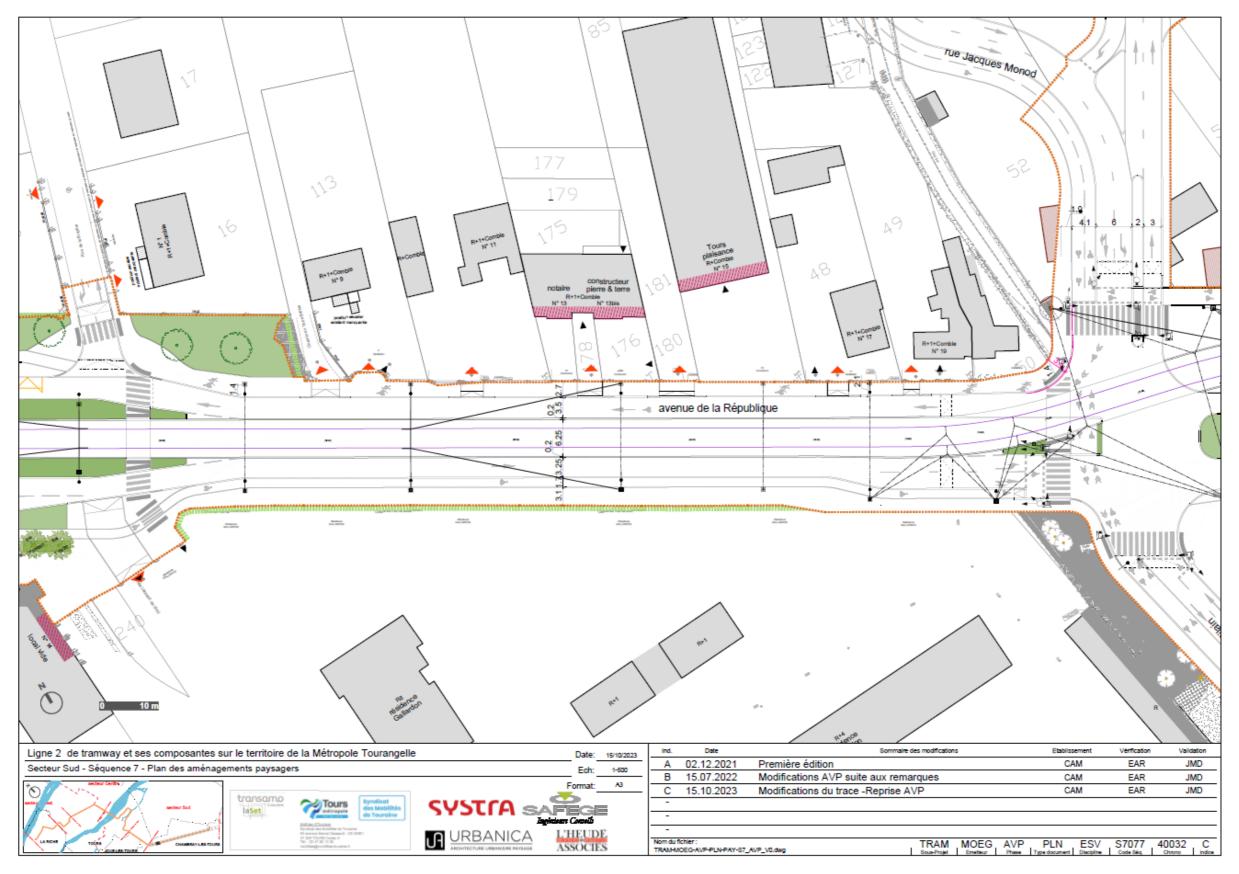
plan masse de localisation des arbres à abattre sur avenue de la République – Section 1 (planche 5)
